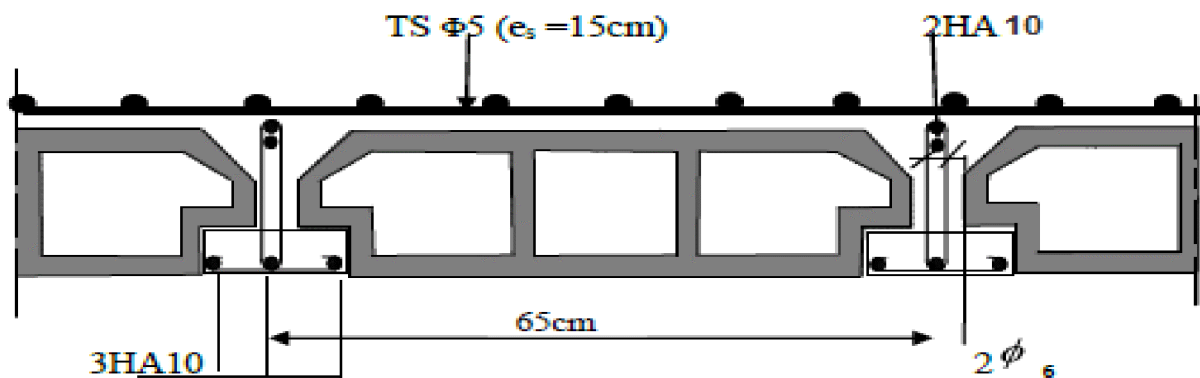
Plan de ferrailage du plancher en corps creux.
